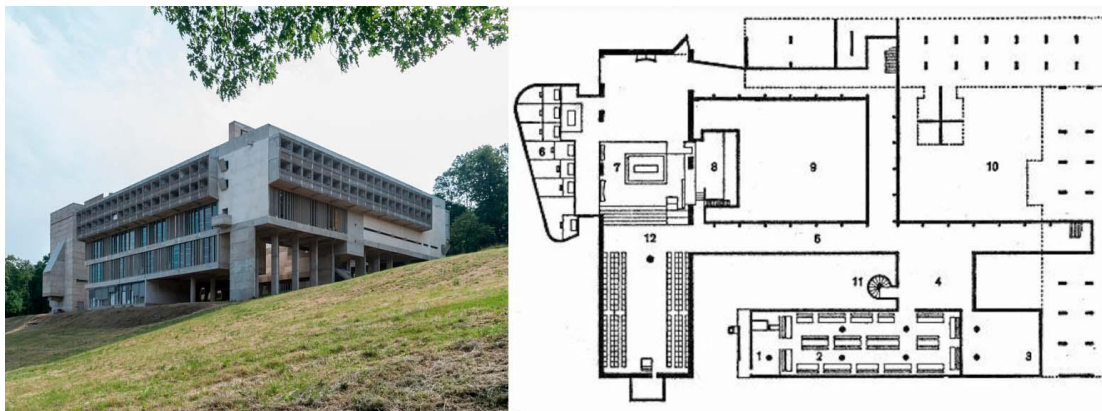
Imagen y planta de Le Convent of La Tourette / Le Corbuiser 2015. Fuente: ArchDaily en español
